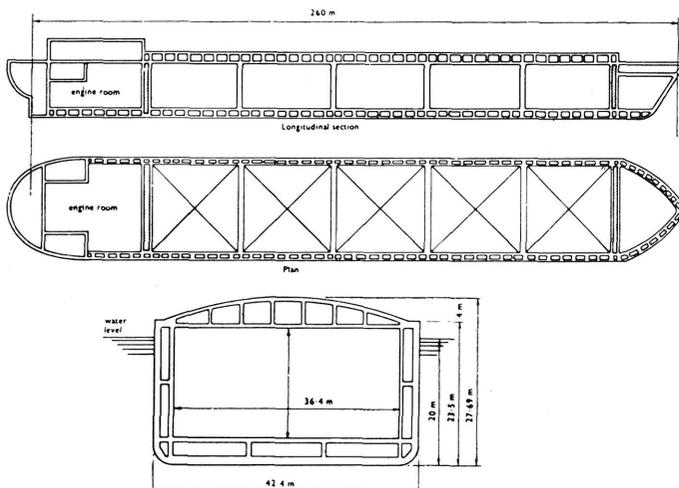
Barco metanero autopropulsado de hormigón, en proyecto.
